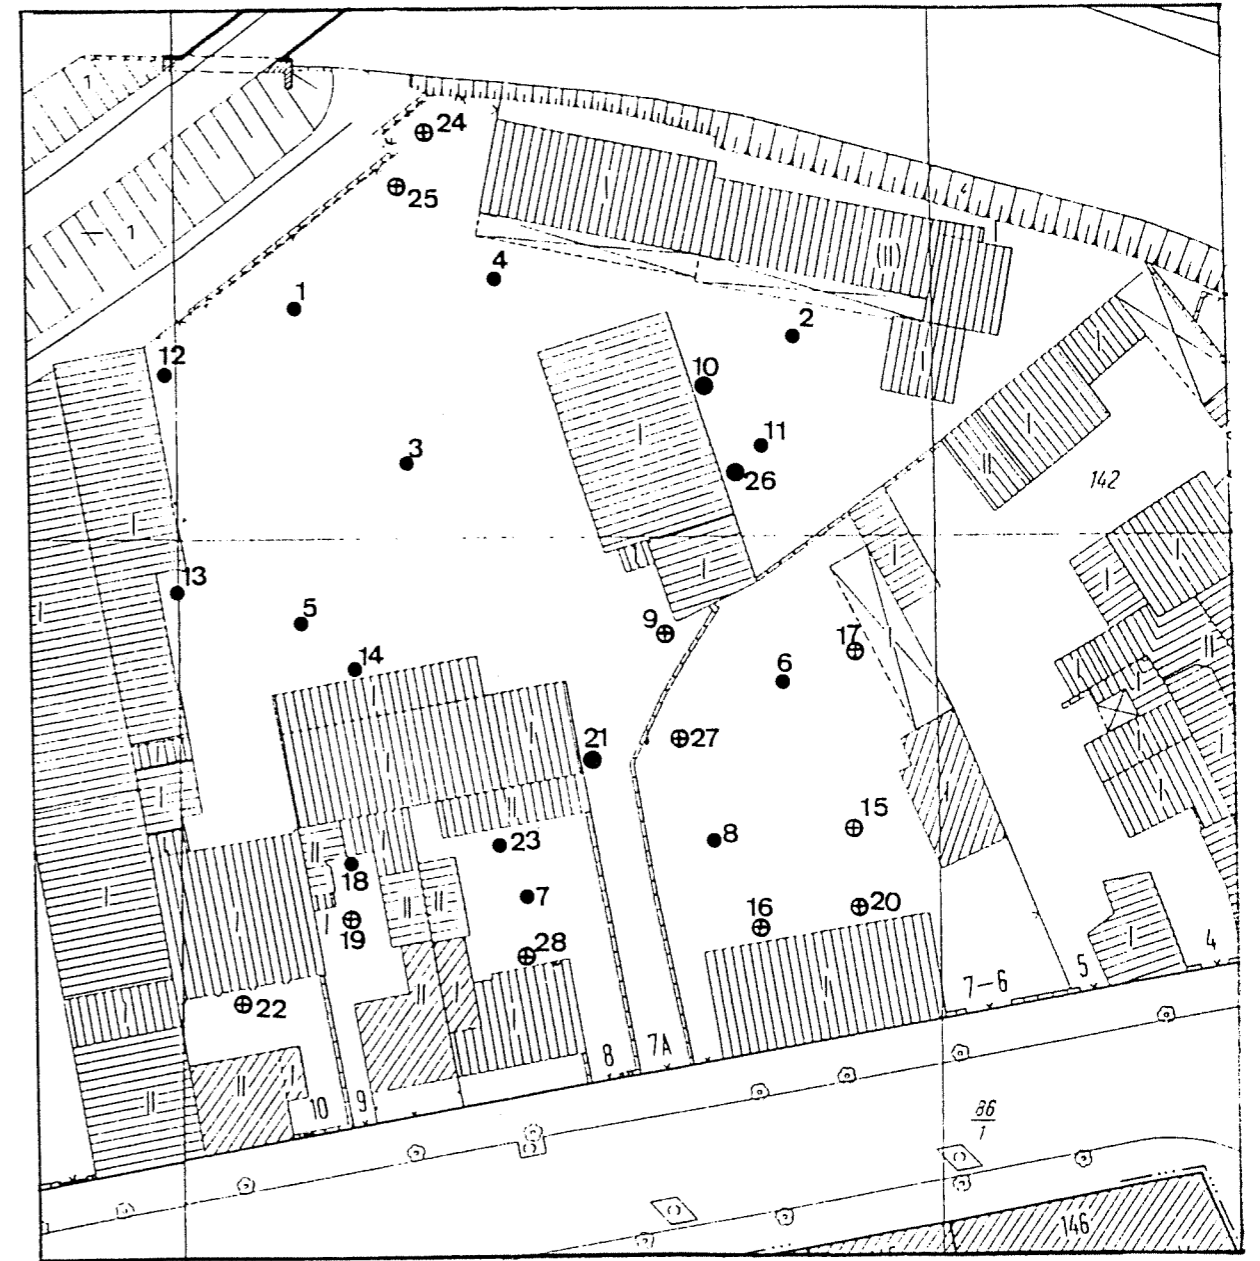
g: Verdachtsfläche 3 - Bohrpunktplan
